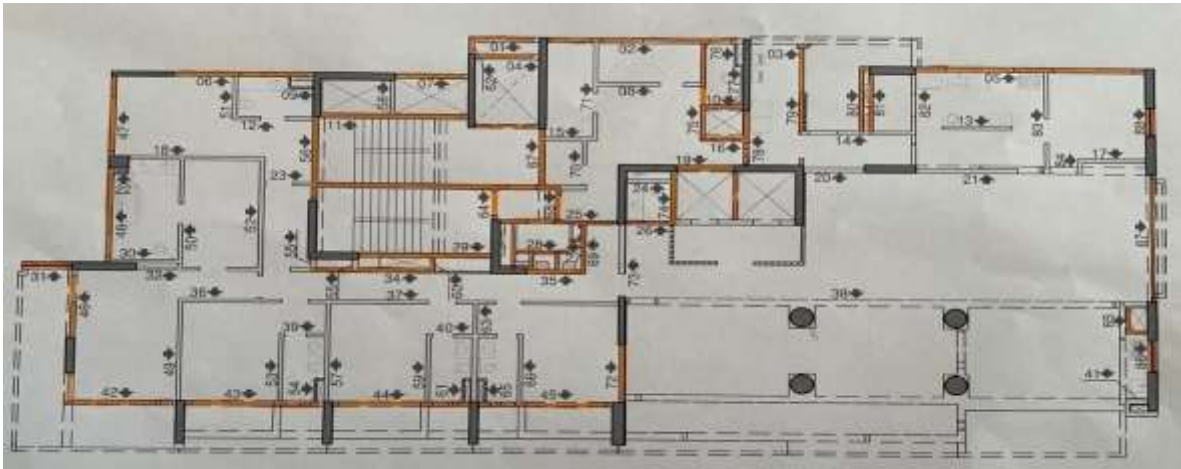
Planta de alvenaria do pavimento tipo do estudo de caso A.
